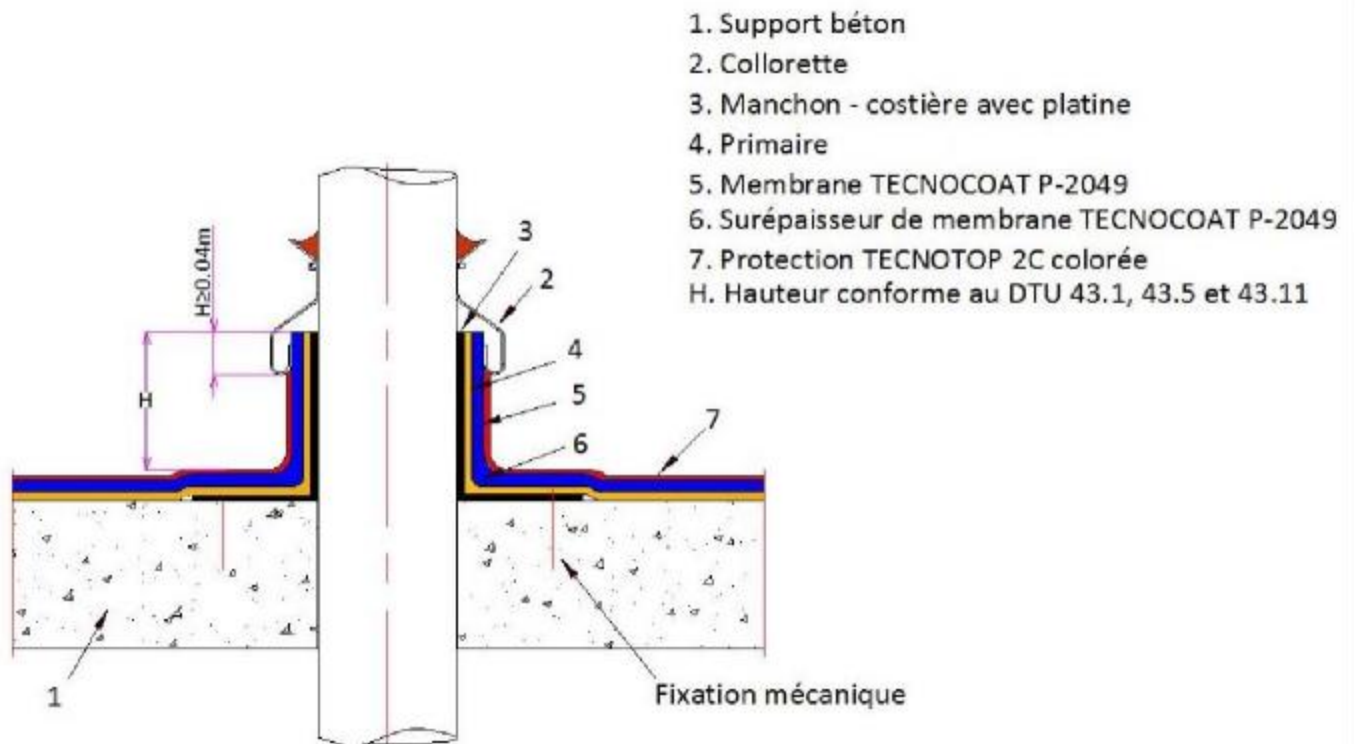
Exemple de traversée de canalisation hors terrasses accessibles
